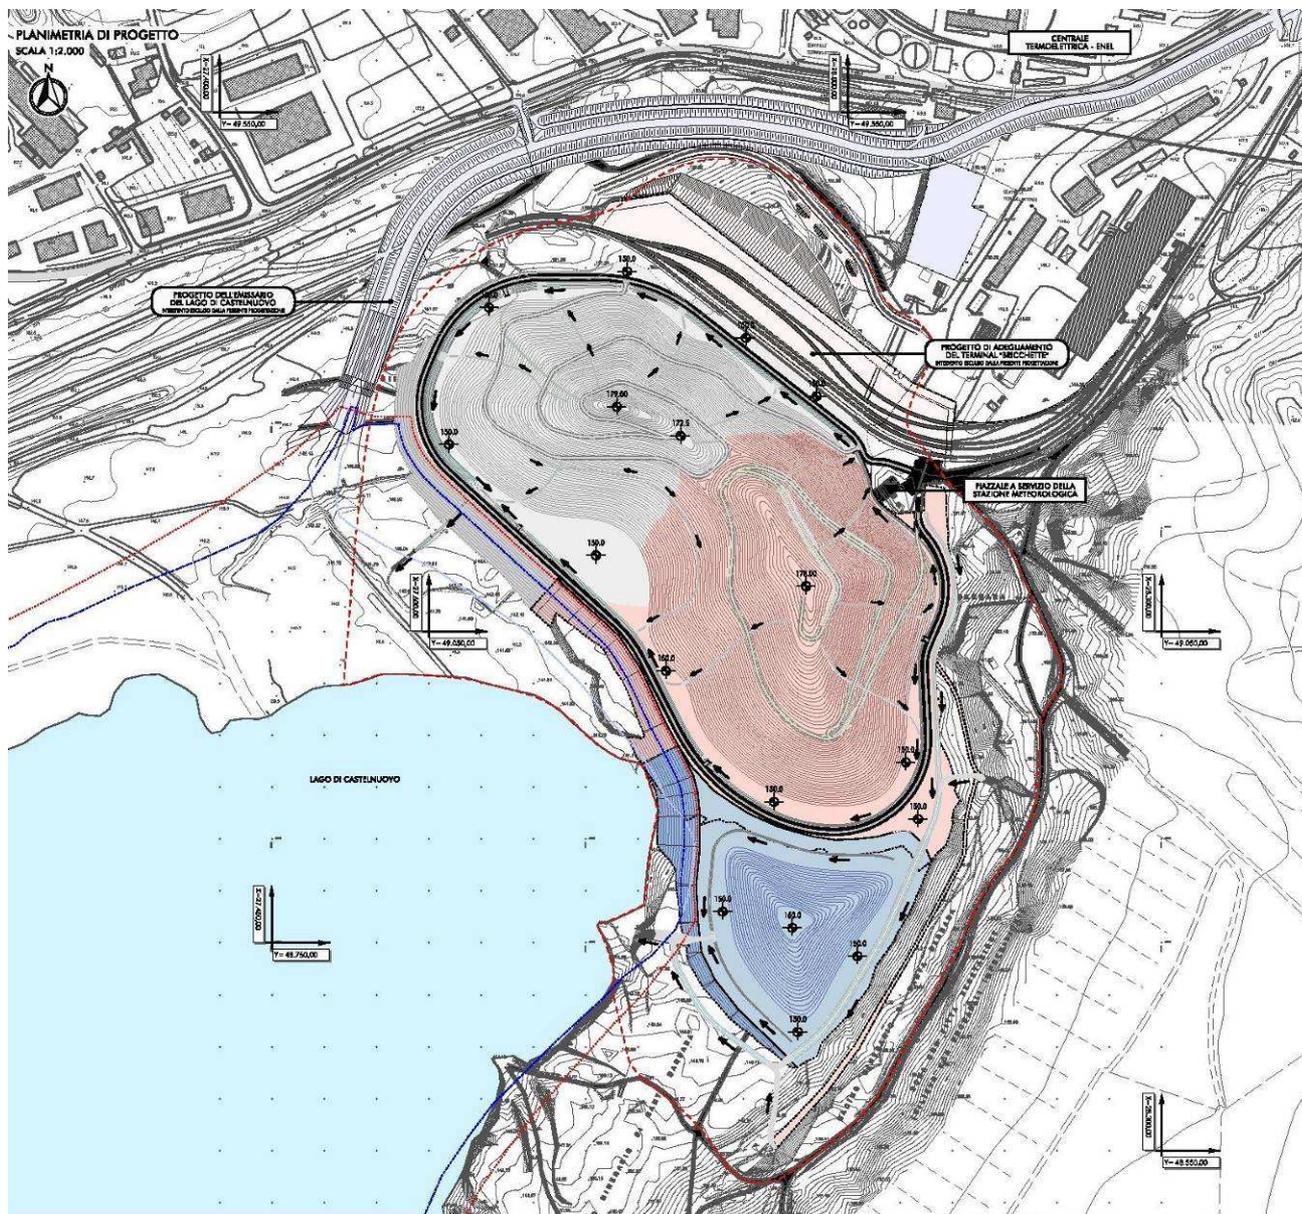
Planimetria generale di progetto della Collina Schermo e degli interventi d'implementazione
